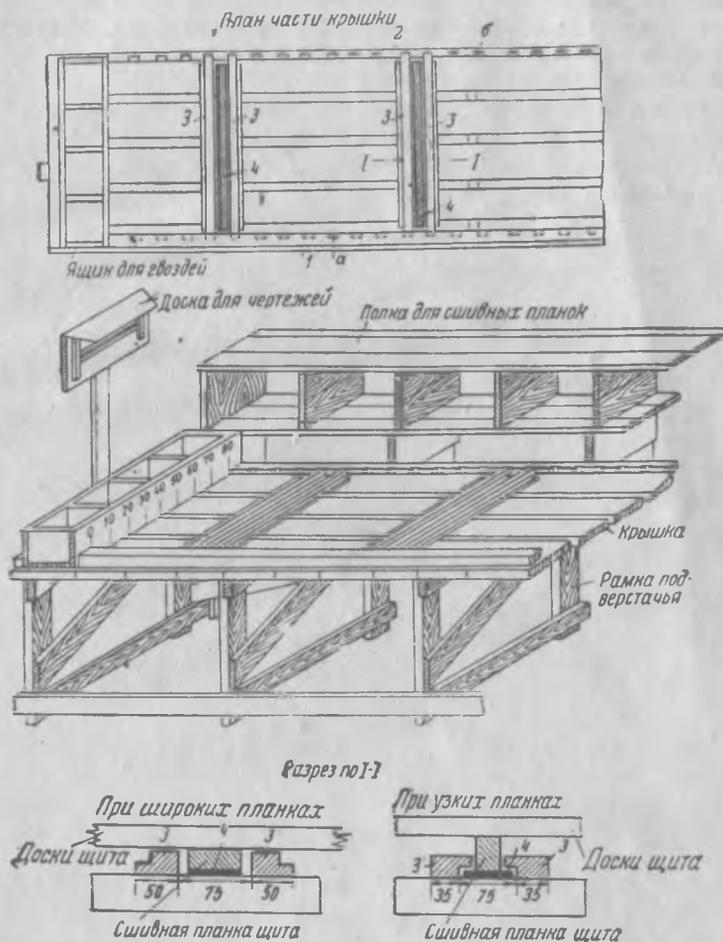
Верстак для сборки опалубочных щитов системы инж. Ефремова
